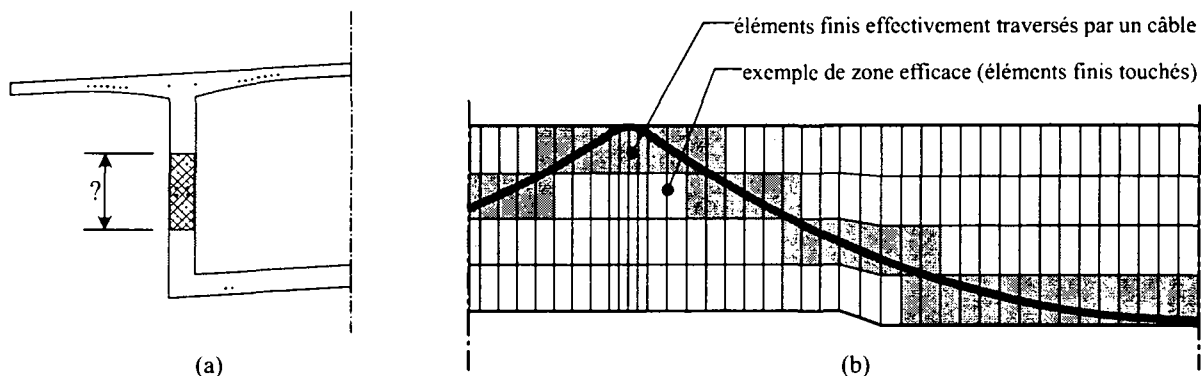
a) Zone efficace d'un groupe de câbles dans l'âme d'un caisson
